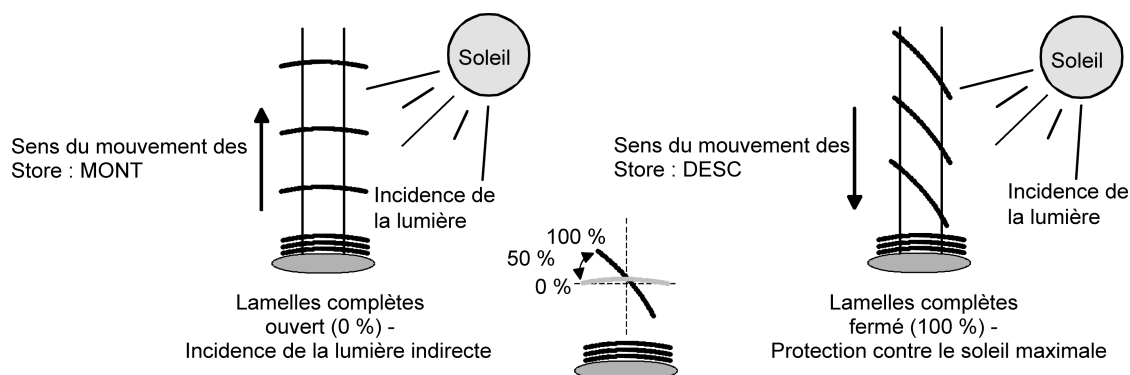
Type 2 - Stores à lamelles avec position des lamelles en biais et droite
